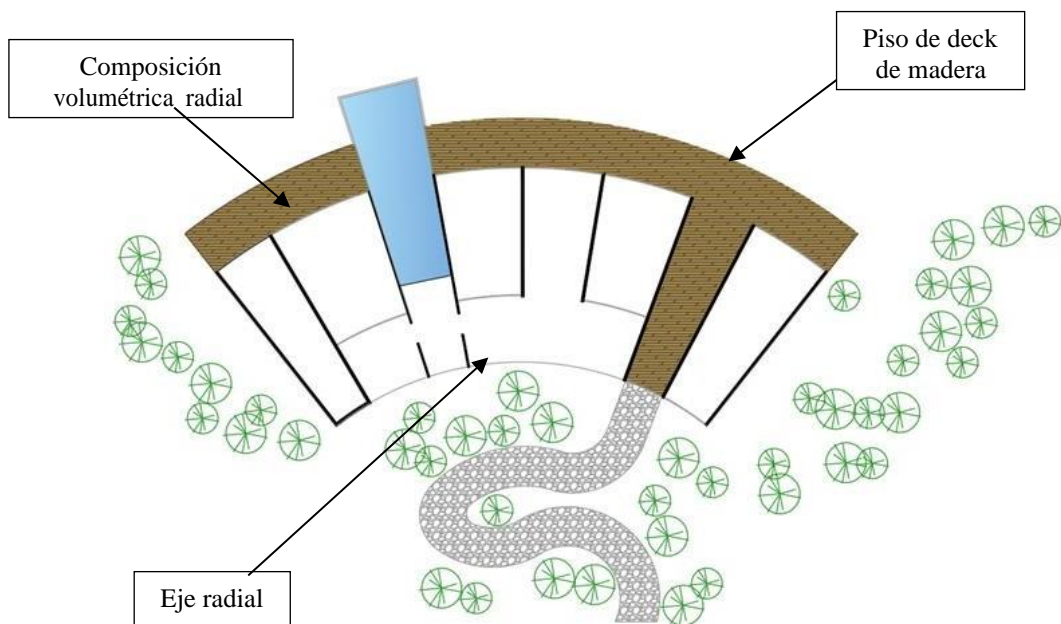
Bosquejo de planta de una habitación en el caso 1.
